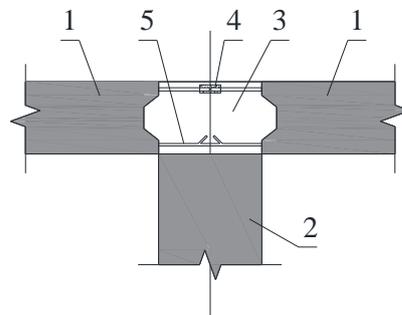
预制板与支承梁或墙连接受力钢筋连接示意图
